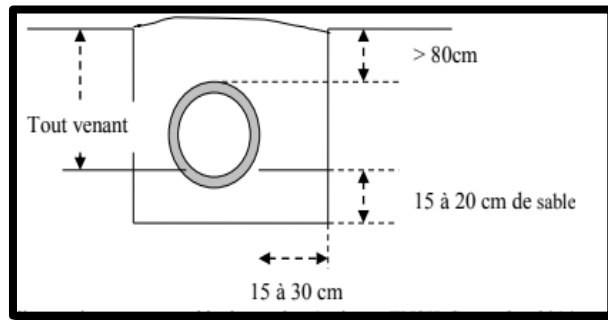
Pose de conduite en tranchée dans un terrain ordinaire (source : SALAH B., 2014)
